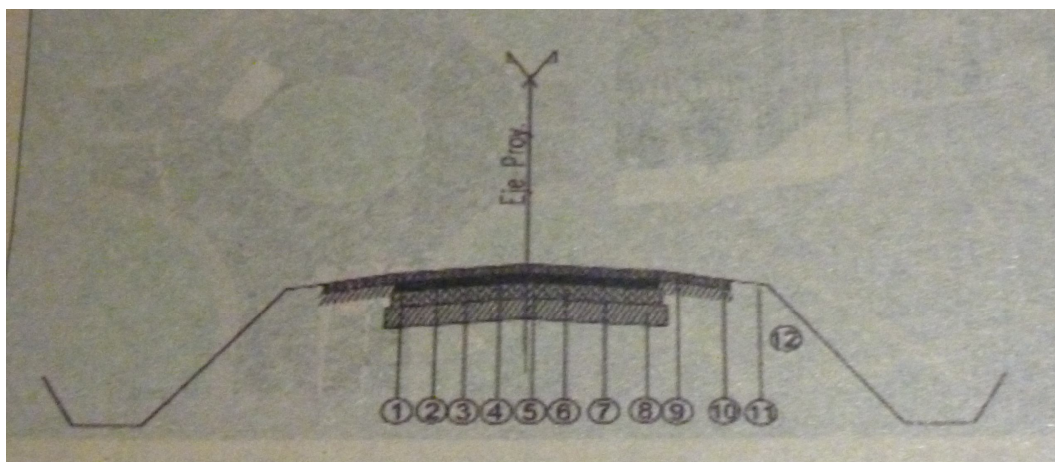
Perfil tipo de la estructura de pavimento.
